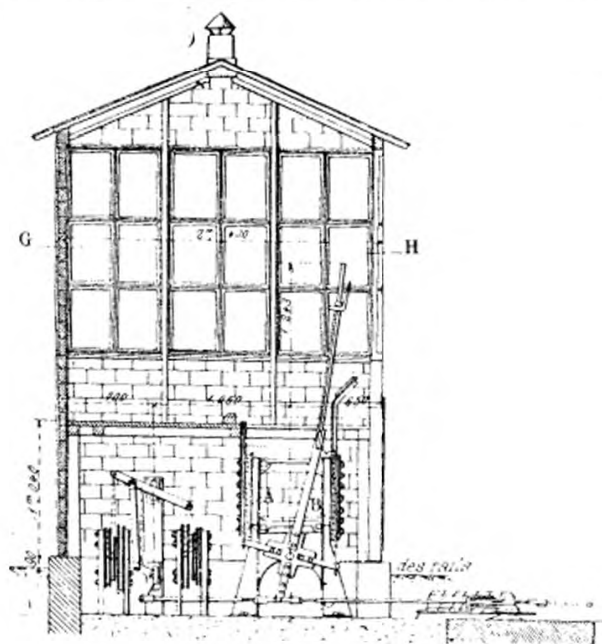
Poste d'enclanchement par transmissions rigides — Coupe transversale.
